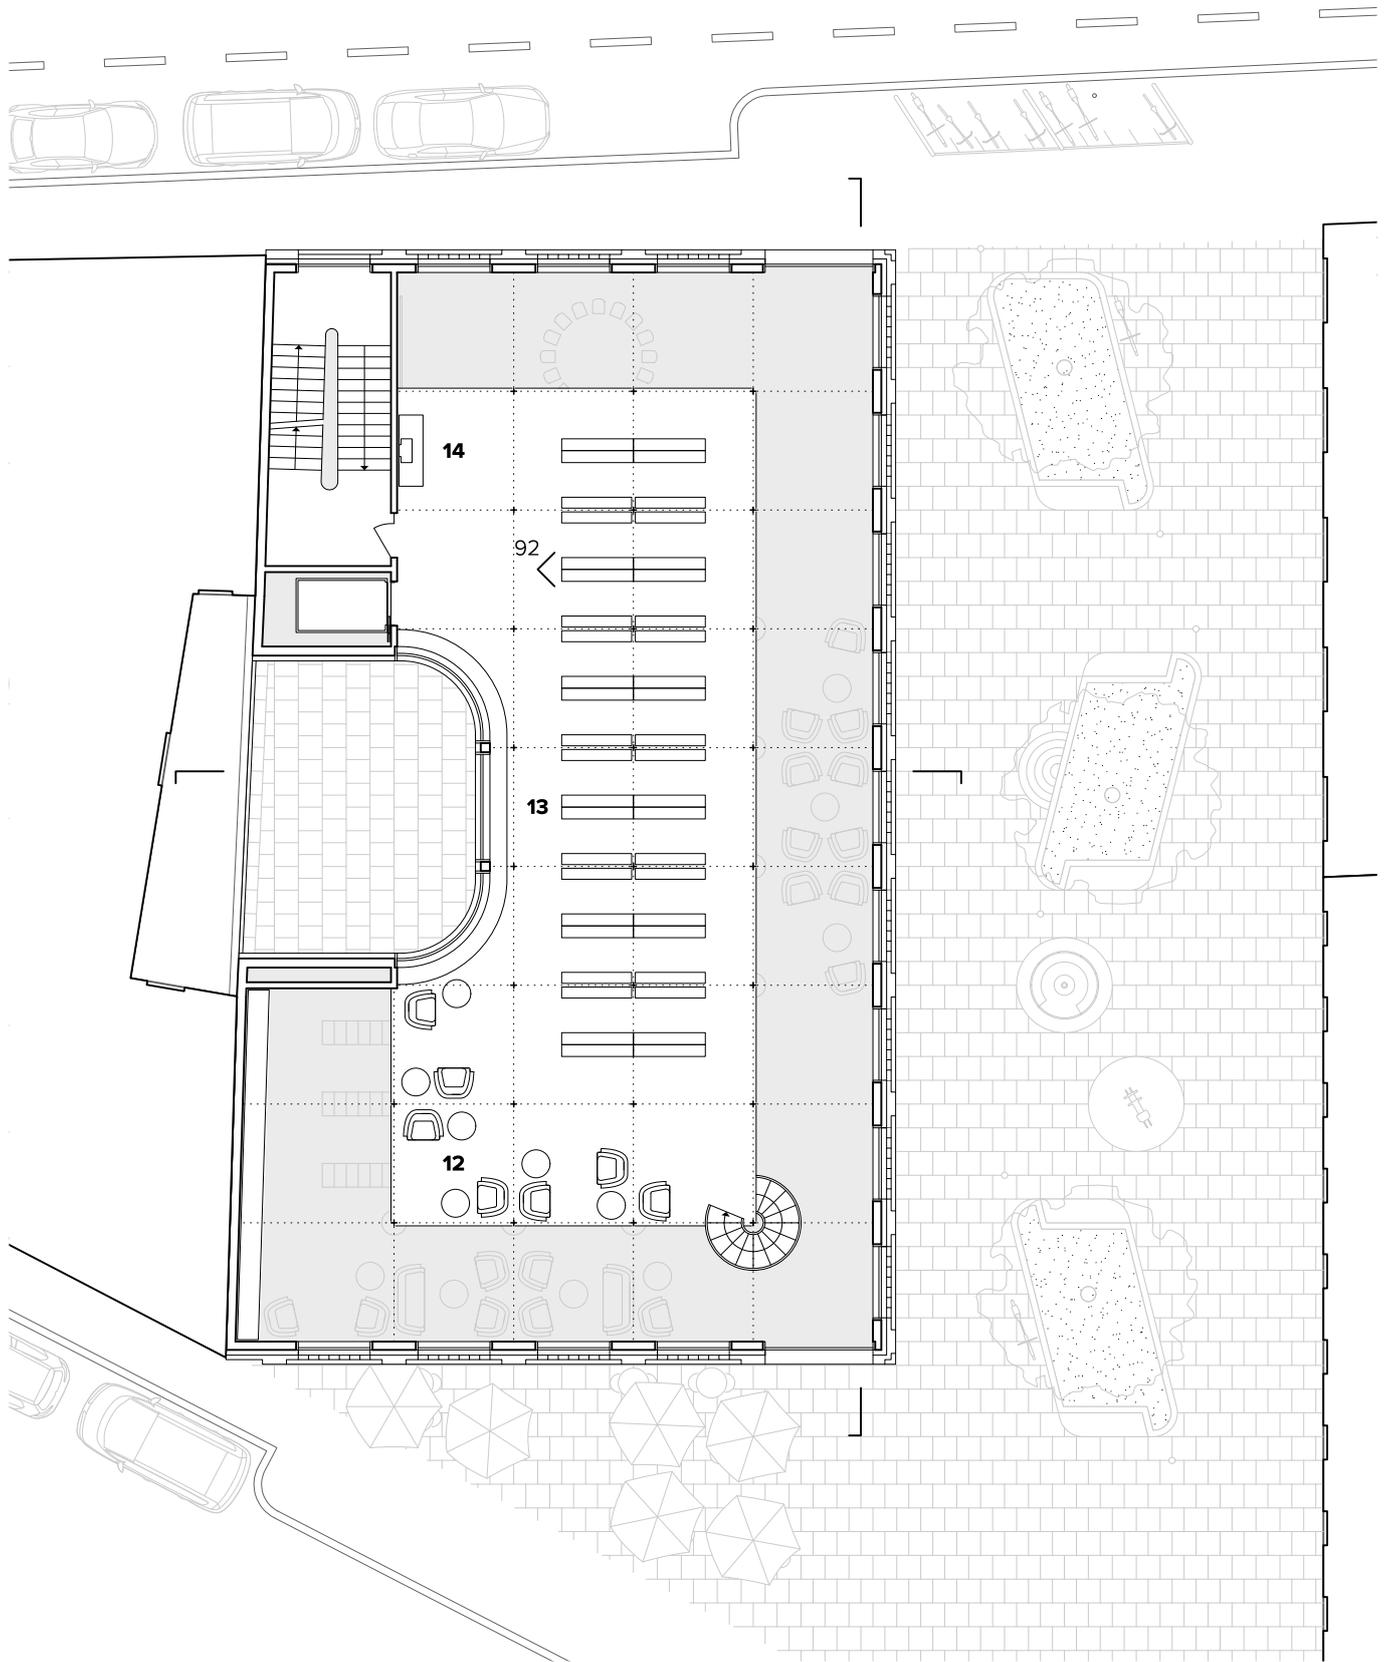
Grundriss 2. Obergeschoss 1.200 (BM)
